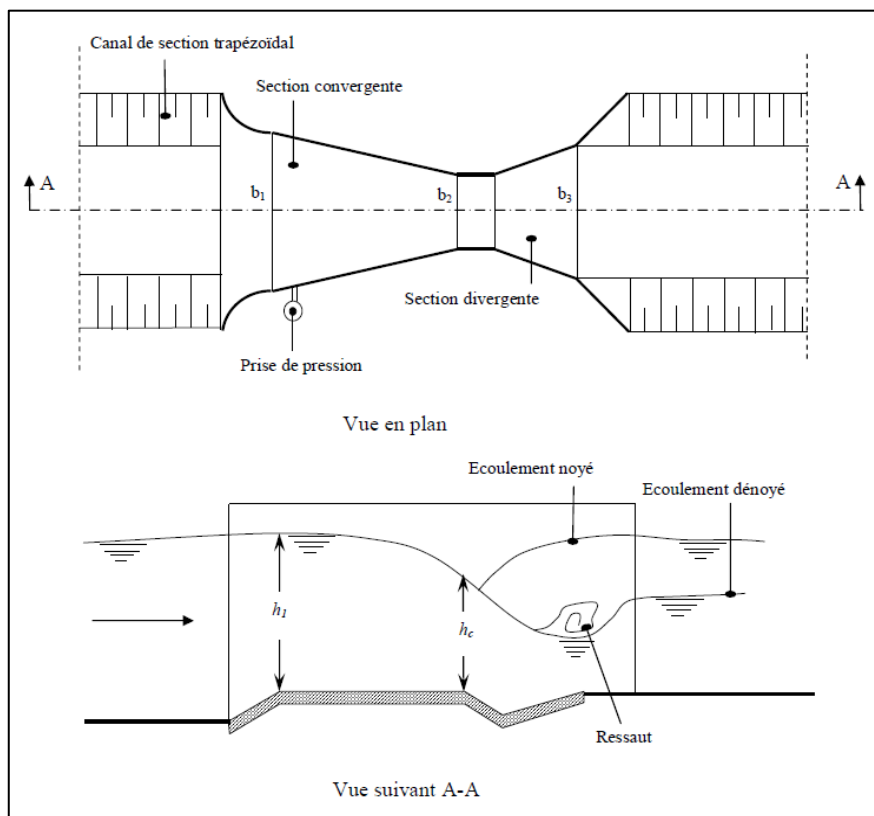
Jaugeur de Parshall—Représentation schématique en plan et de profil-
